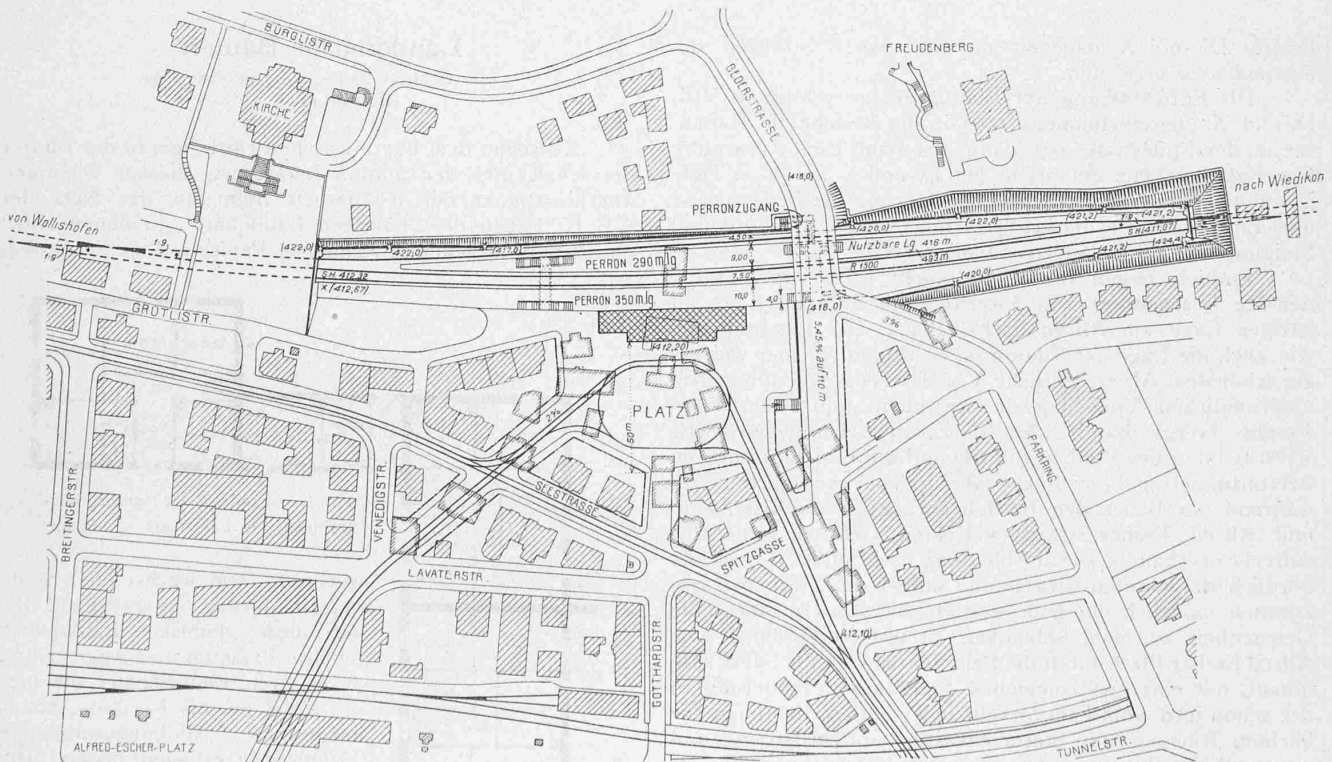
Lageplan zu Projekt X (ohne Eilgut und Einführung der Sihltalbahn). — Masstab 1 : 3000.
